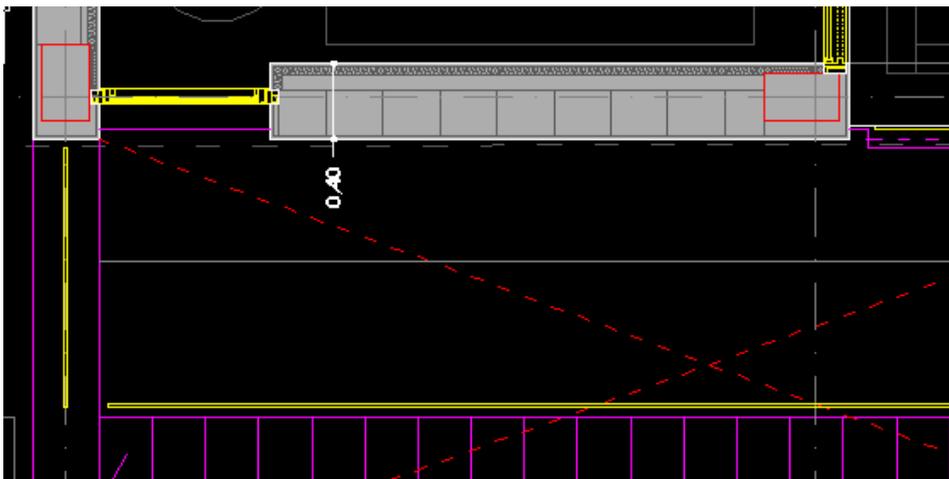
Plano de proyecto en formato Cad. dónde se aprecia el espesor de muro. (Fuente propia)
